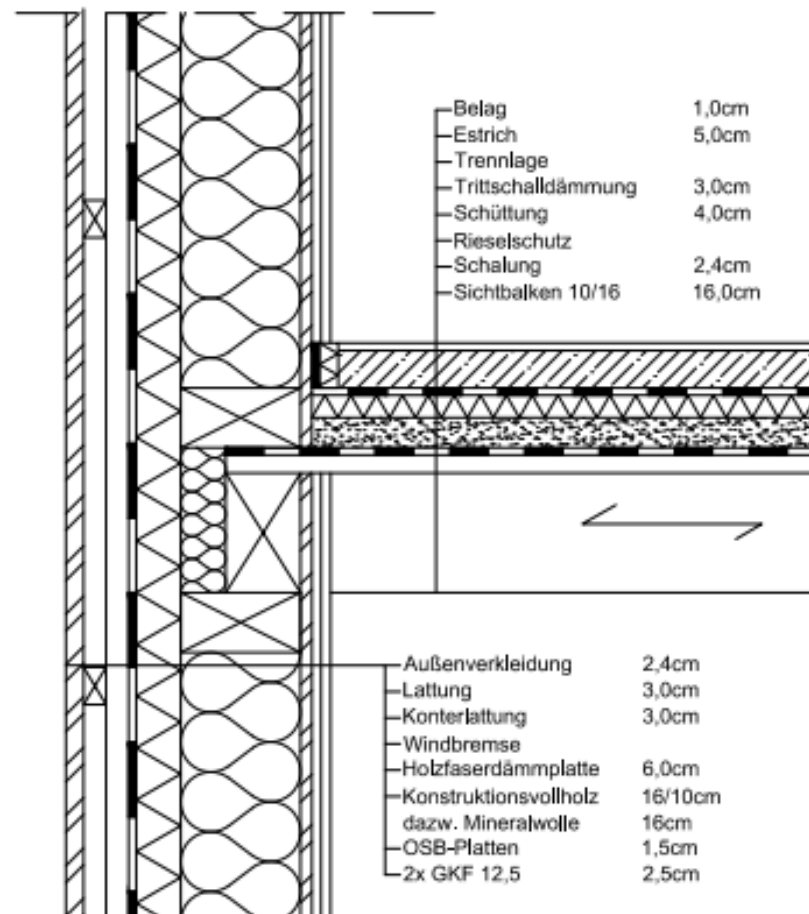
Detail 02 - Anschluss Geschoßdecke an AW
